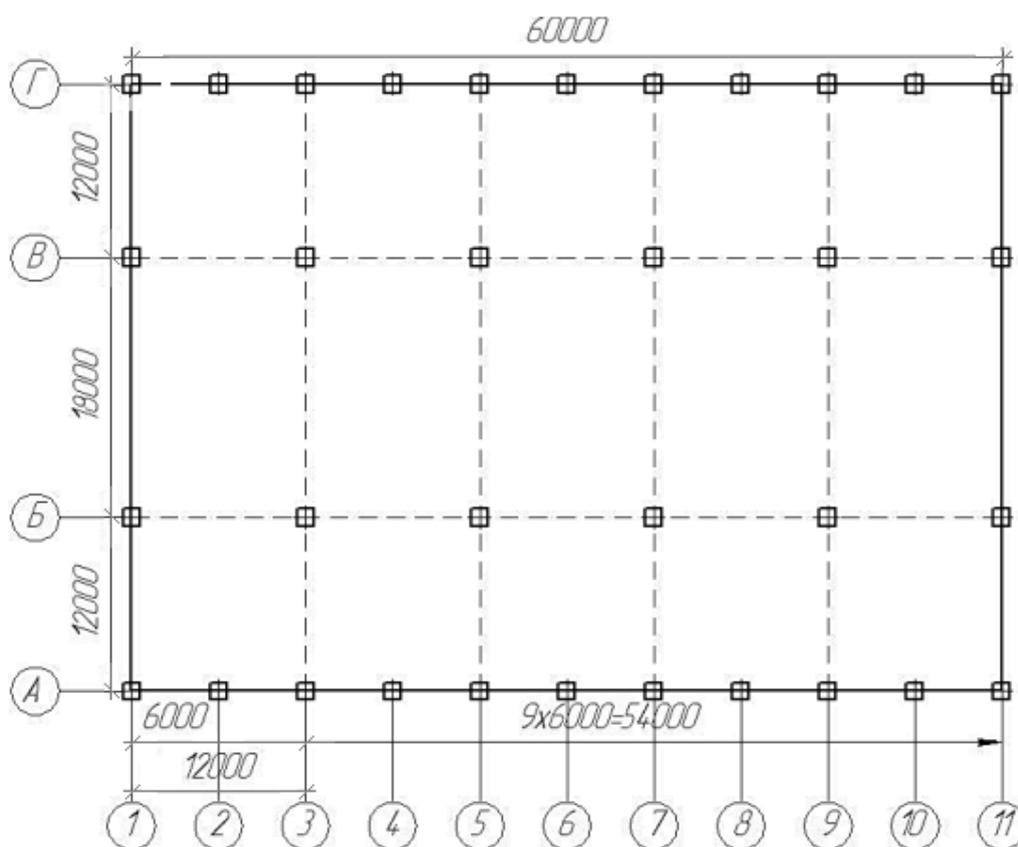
Нанесение размеров и координационной сетки на чертеже плана производственного корпуса (обозначены места установки колонн)
